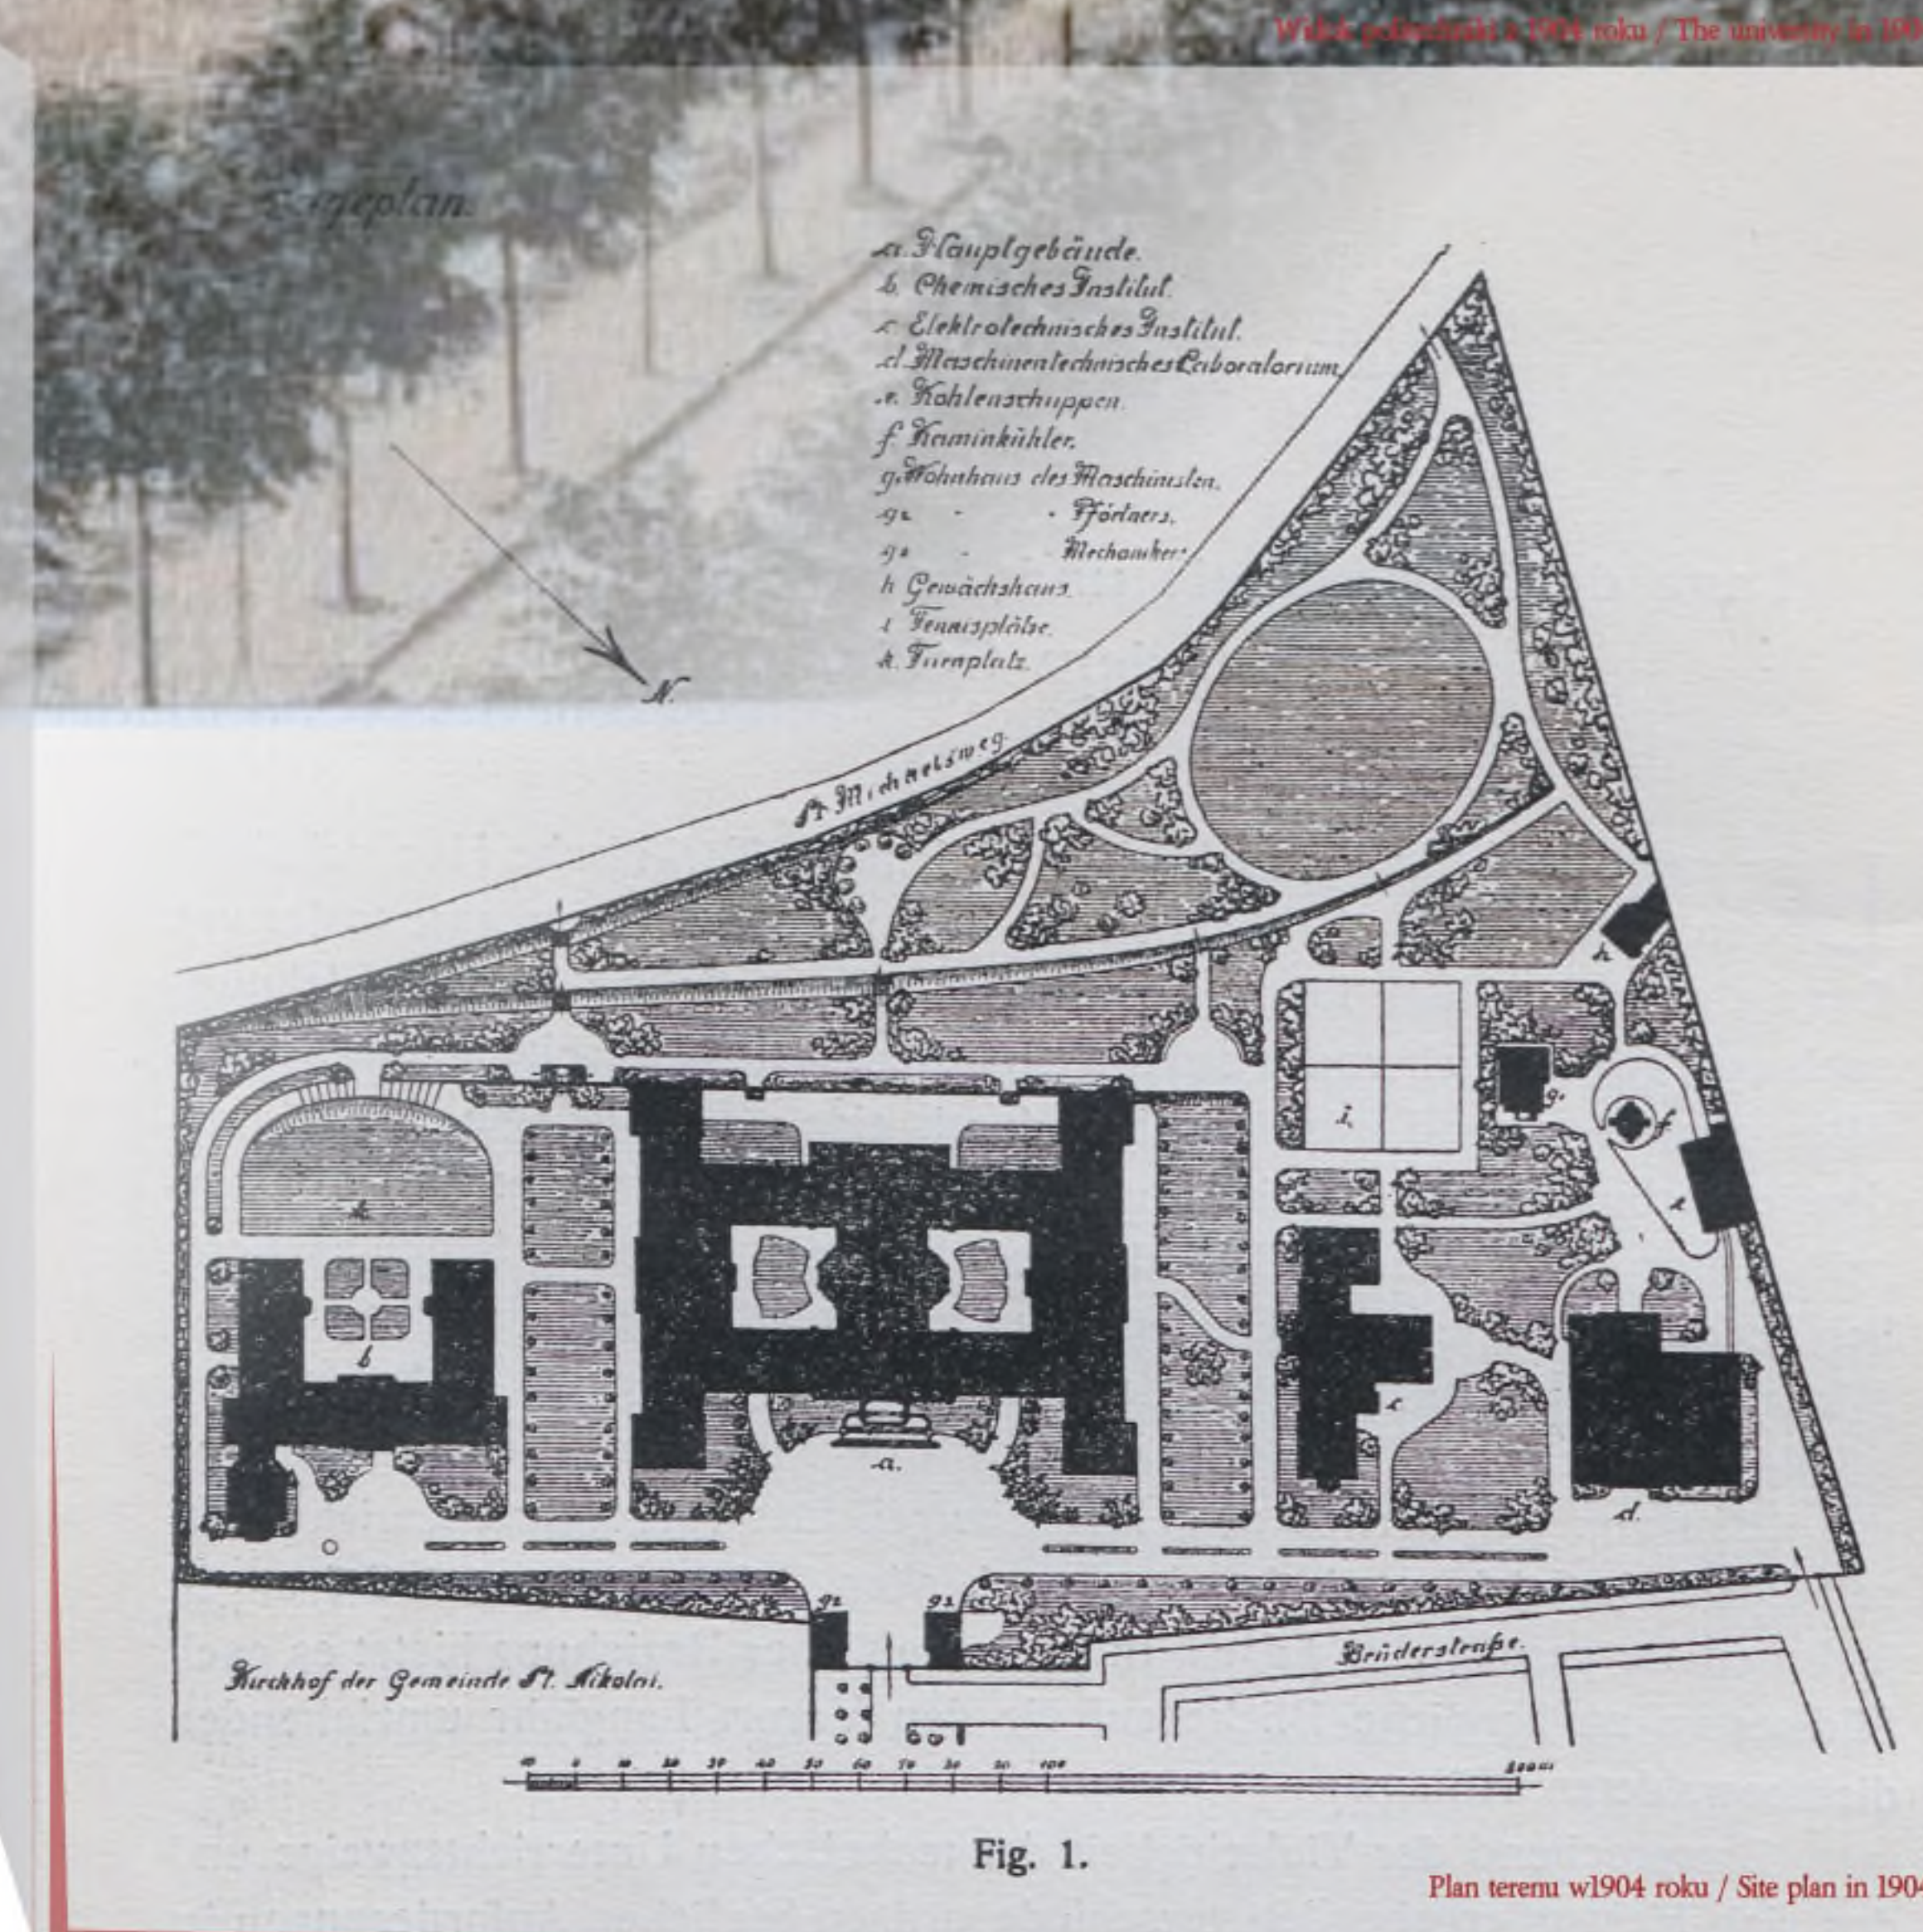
Plan terenu w1904 roku / Site plan in 1904.
